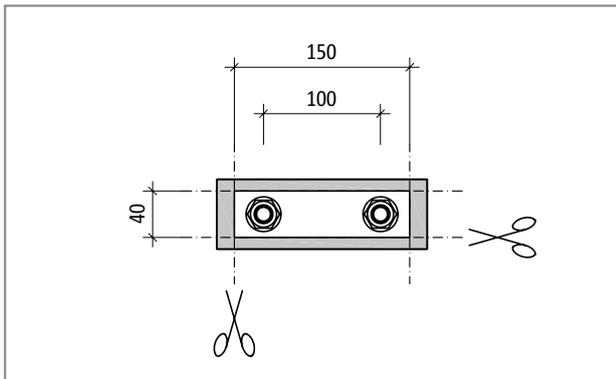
Schöck Isokorb® T Typ S-N: Maße nach Abschneiden des Dämmkörpers
